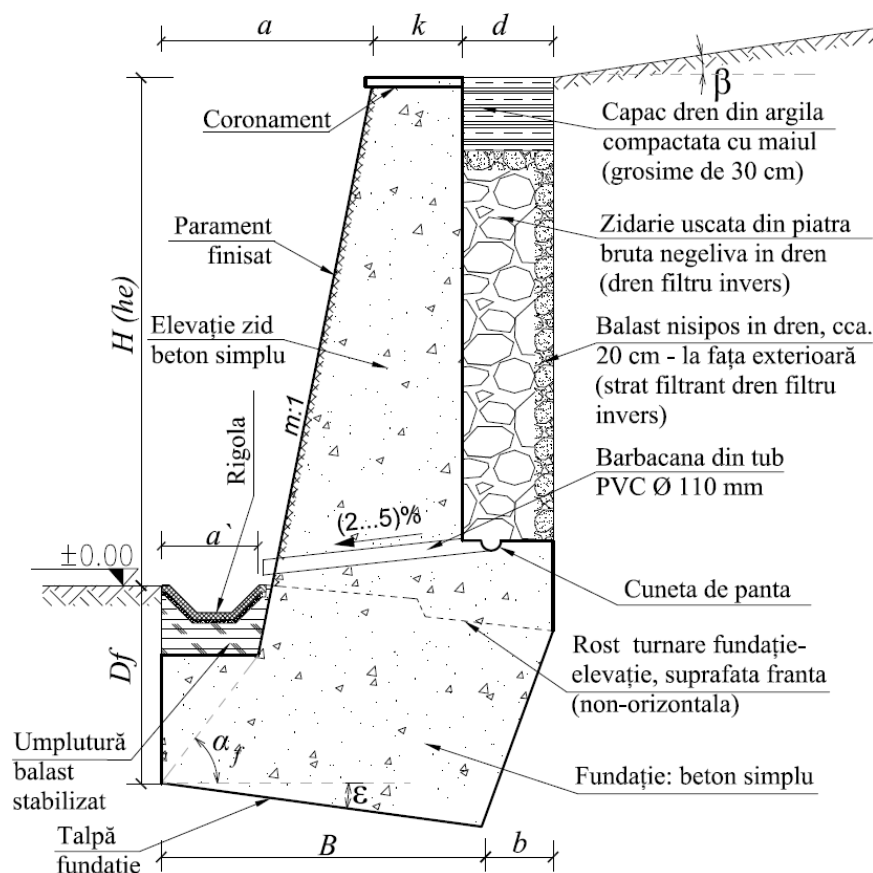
Secțiune transversală zid de sprijin din beton simplu
